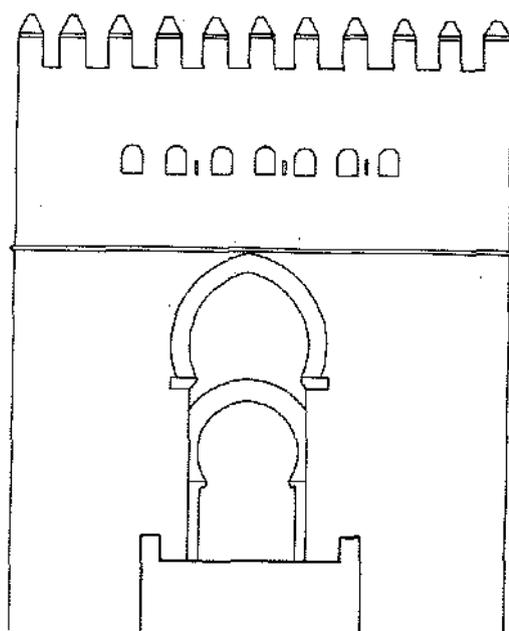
Esquema de la fachada interior. Torre exterior del Puente de San Martín. Toledo.
